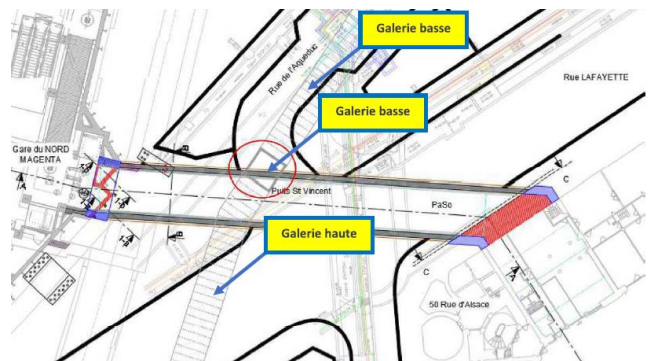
Plan d'implantation du puits St-Vincent et des galeries.
